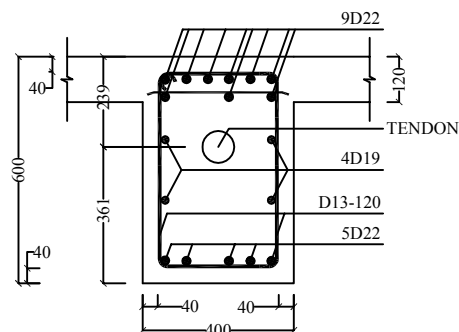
### DETAIL PENULANGAN BALOK PRATEKAN BP1
